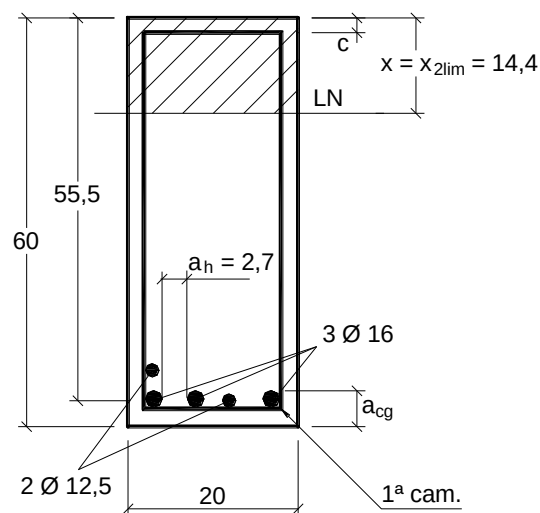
Detalhamento da armadura na seção transversal e posição da linha neutra em $x = x_{2lim}$.
